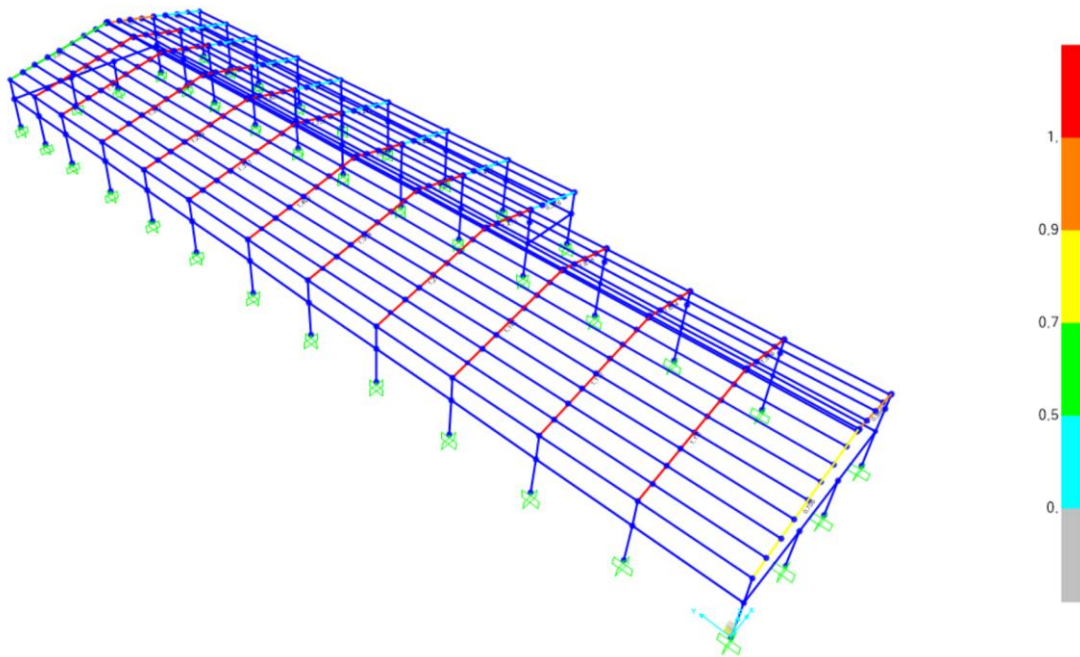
24: Vista general de los problemas de diseño en el sistema de cubierta
